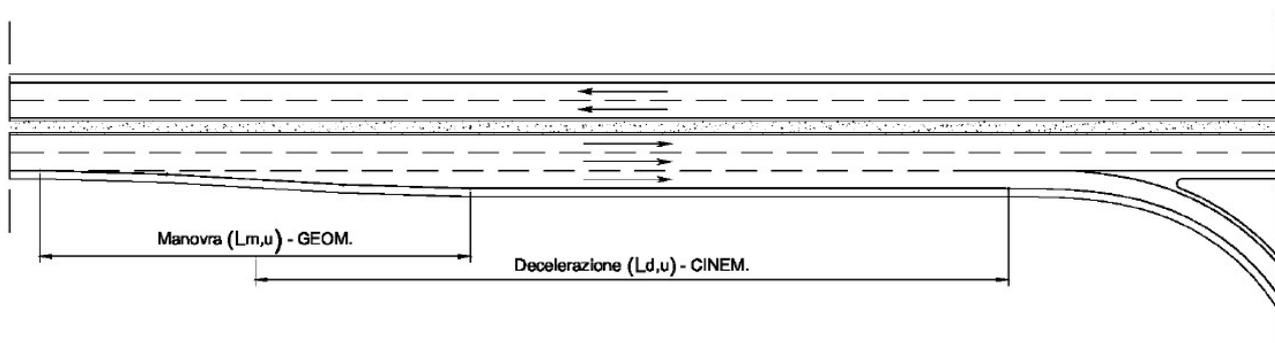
Stralcio planimetrico rampe di uscita
